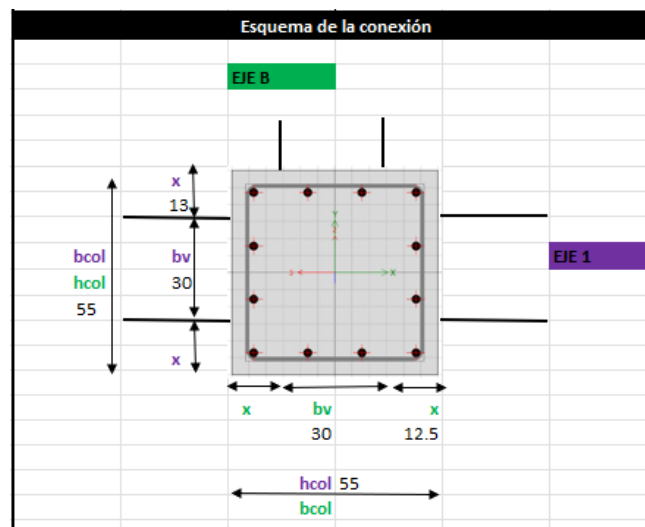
Esquema de la conexión viga-columna B1 para los pisos 1, 2, 3 y 4.
